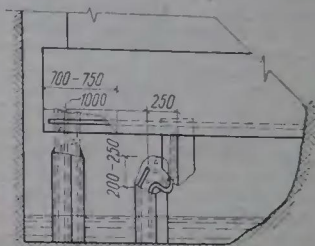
Вид поломанных свай ниже подошвы ростверка
